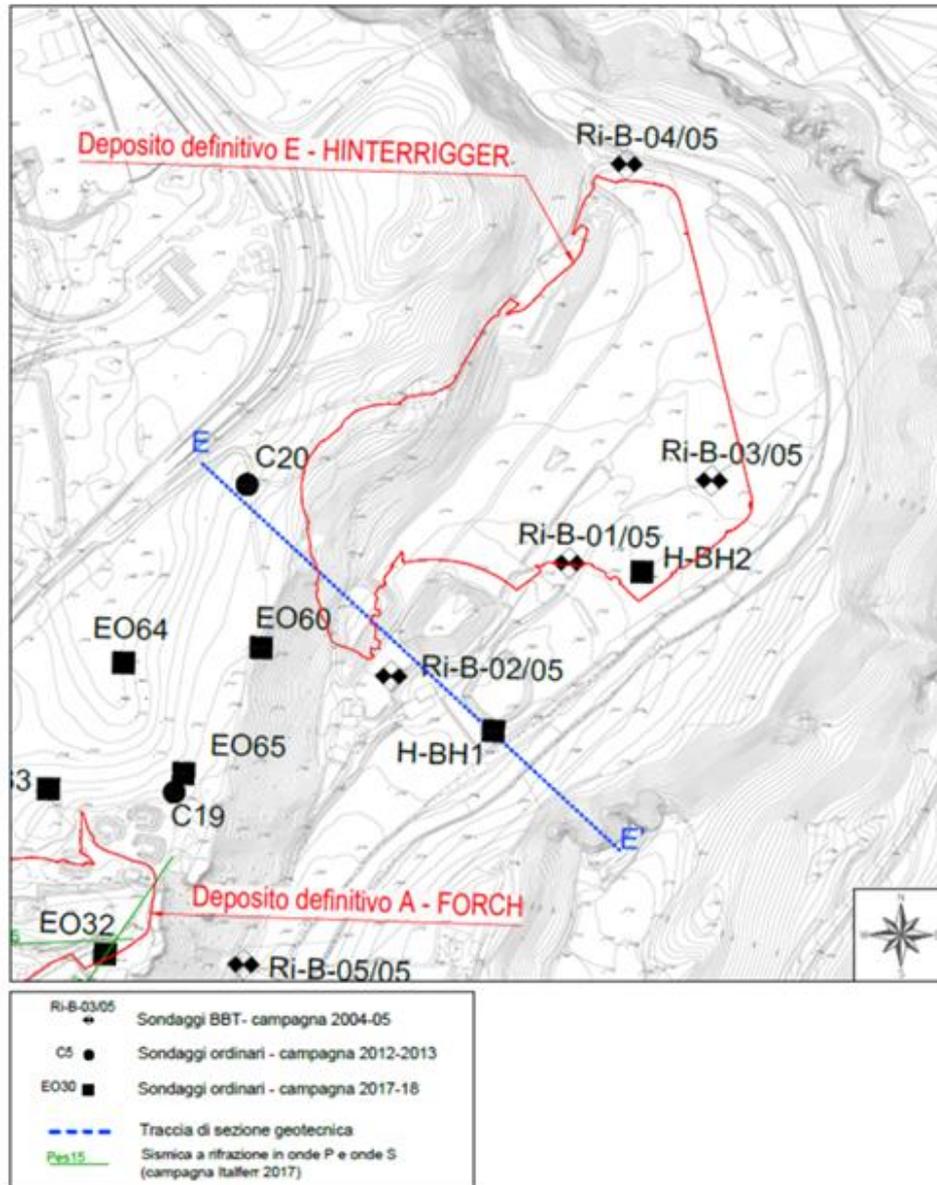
Planimetria dell'area con ubicazione delle indagini.
